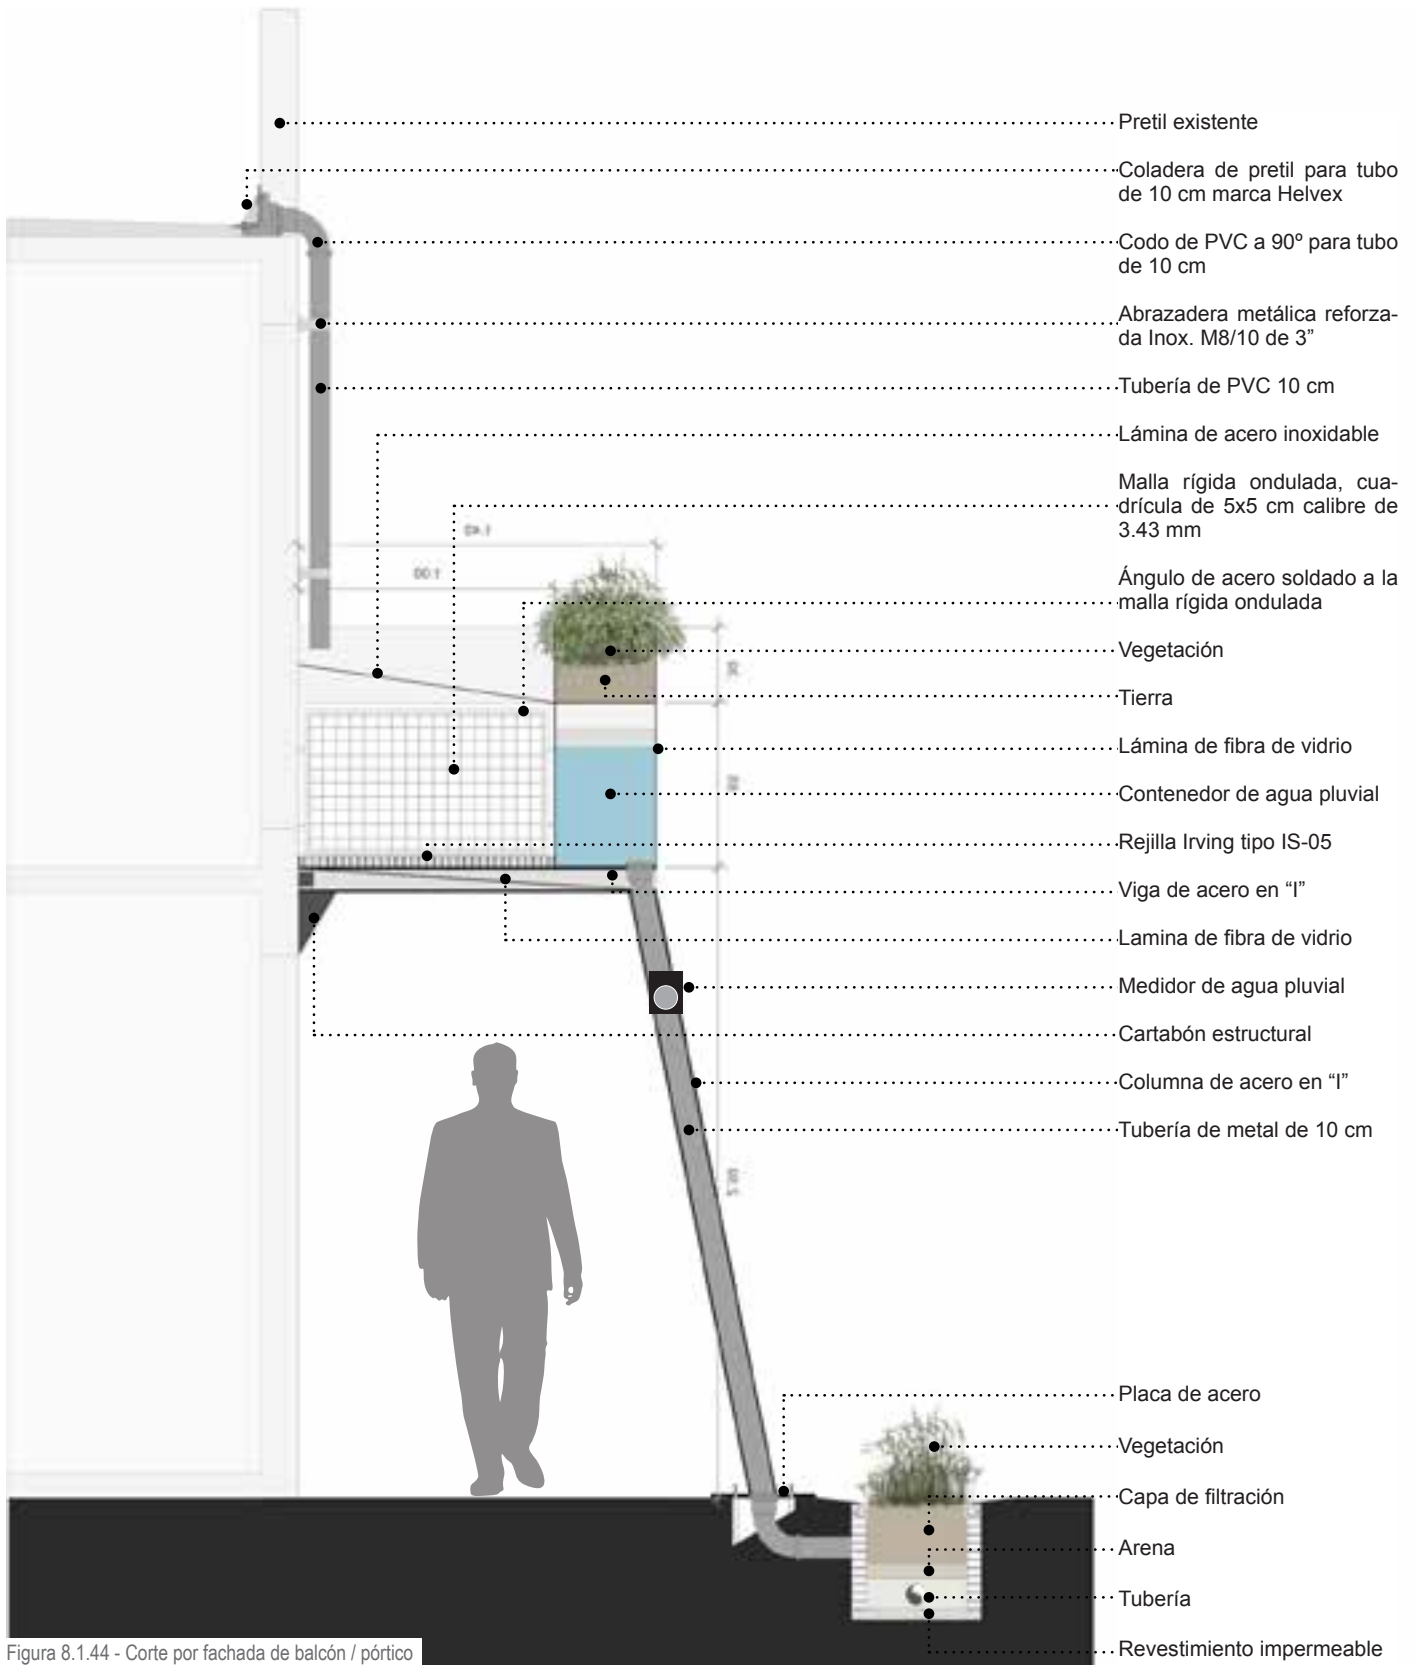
Corte por fachada de balcón / pórtico
